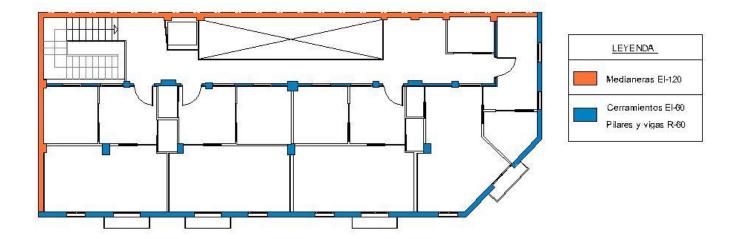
Plano de planta primera con resistencia al fuego estructural y de cerramiento. Elaboración propia
